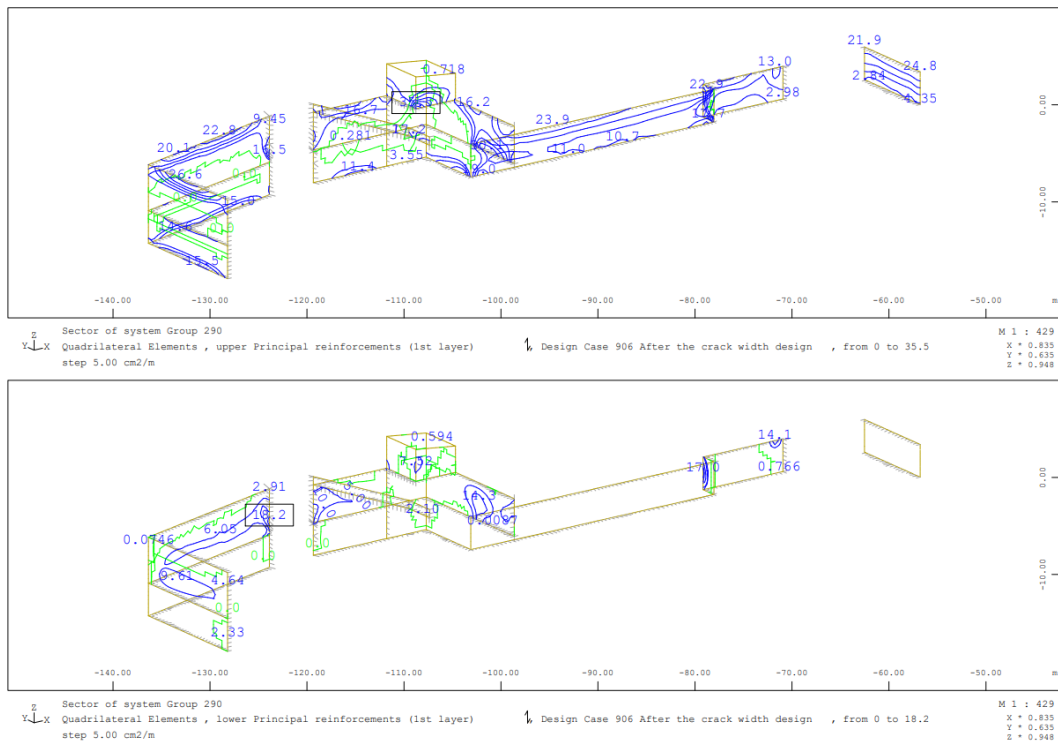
Armadura vertical na face exterior (sup.) e interior (inf.) – muros – acesso Norte – ELS
